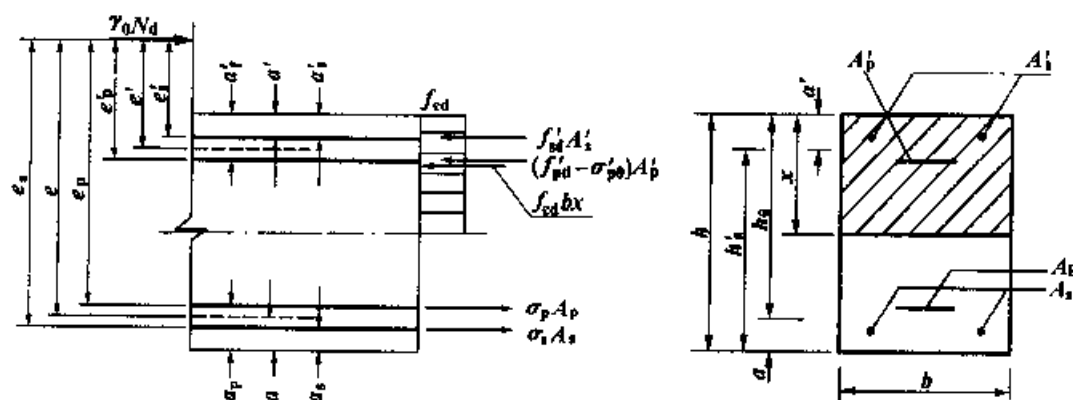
预应力混凝土矩形截面偏心受压构件正截面承载力计算图式
